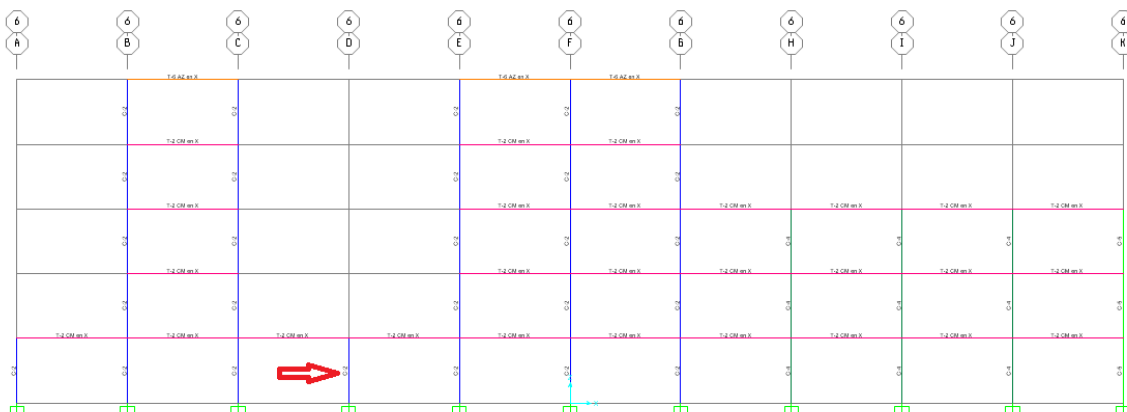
Ubicación de la columna (C2) en SAP2000.
